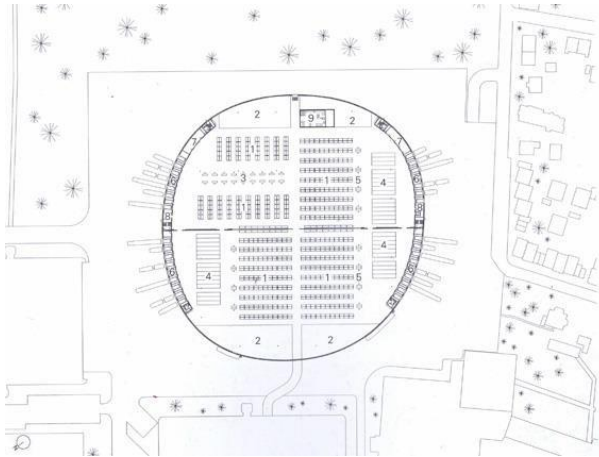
Fuente: Fotografía de SANNA (planta de la Nave de Producción)
